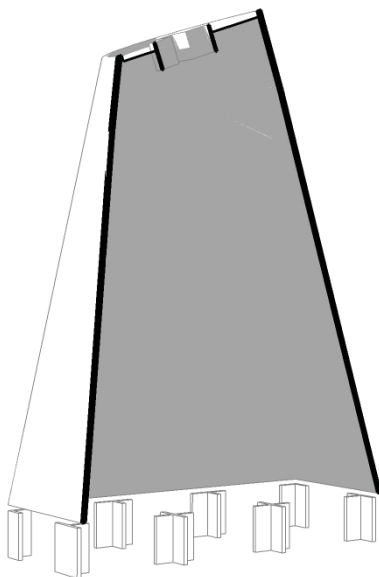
Estructura de la cáscara apoyada en muros pantalla. Fuente: MCHS.
